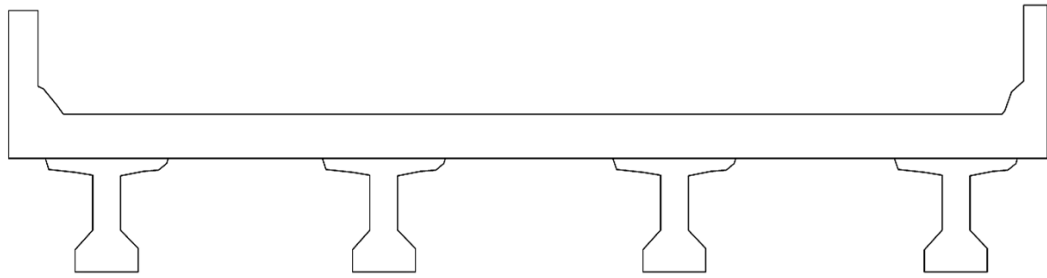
Sección transversal de puente con vigas doble Te o tipo I (AASHTO, 2007).
